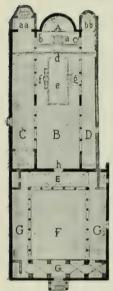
Grundriß einer altchristlichen Basilika (S. Clemente).
